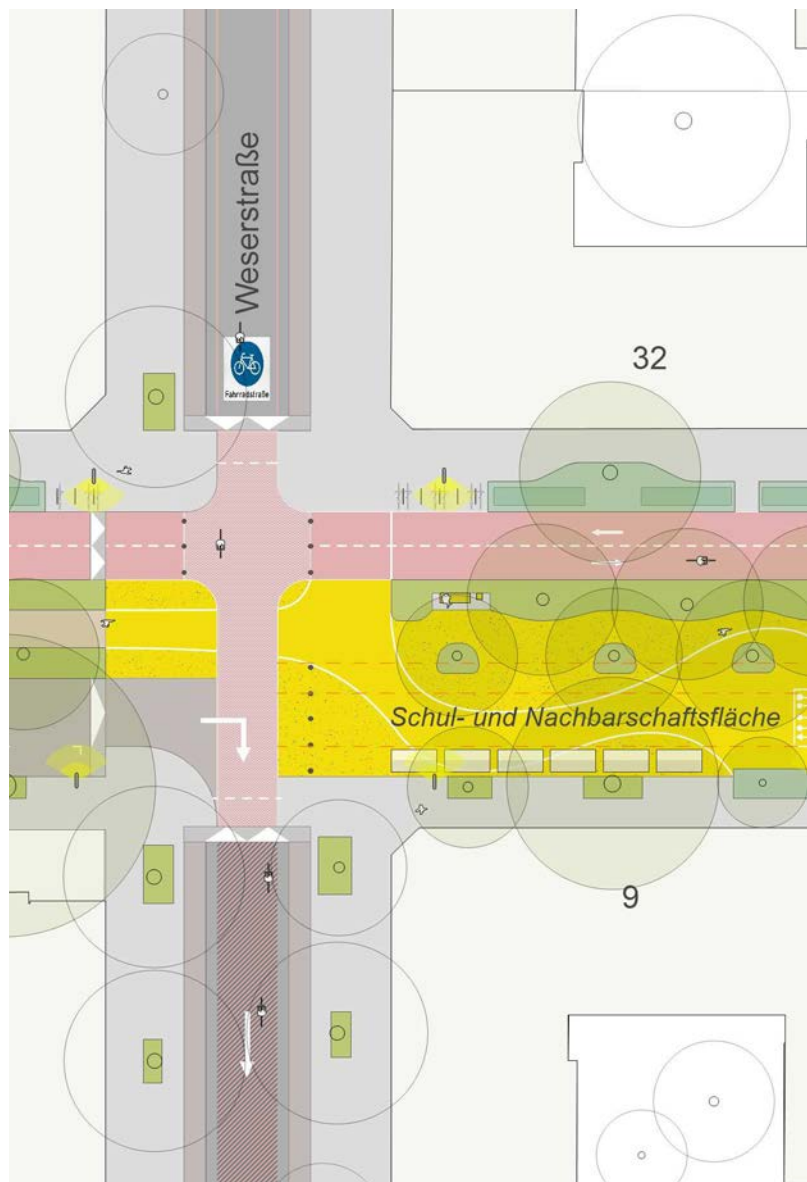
Lageplan Ausschnitt 1:500 Var 5.1 mit großer Nachbarschaftsfläche
